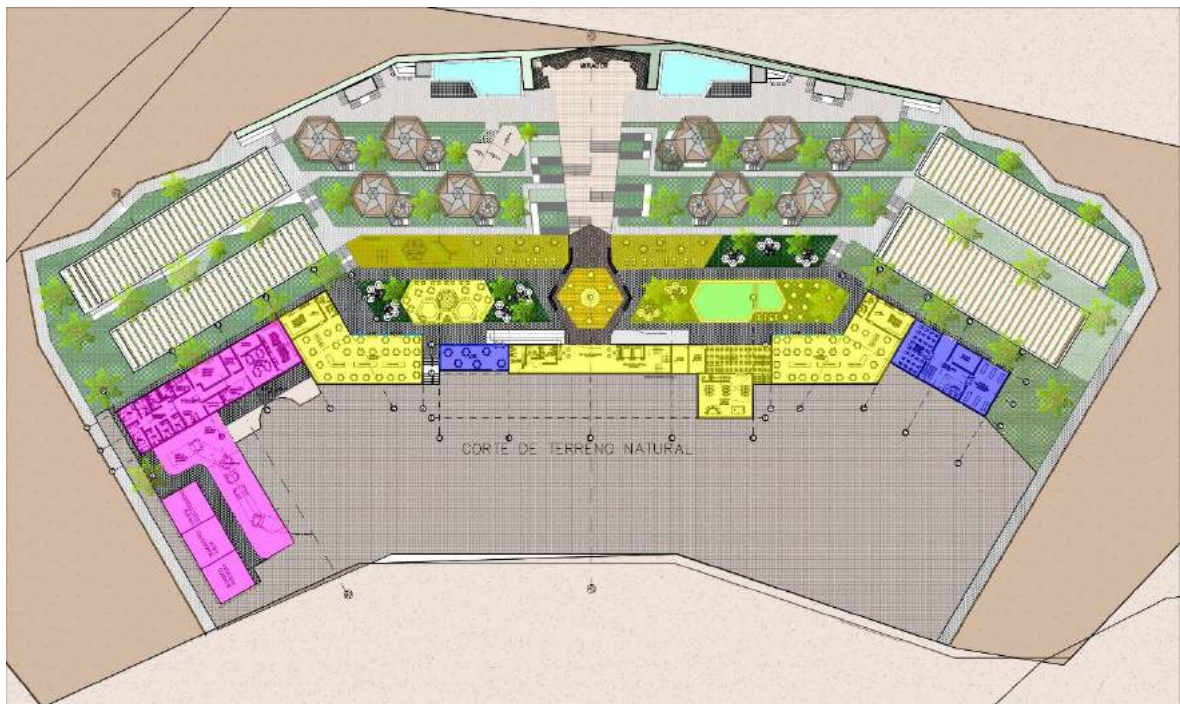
Zonificación Planta Baja (N.P.T: +27.00m)
